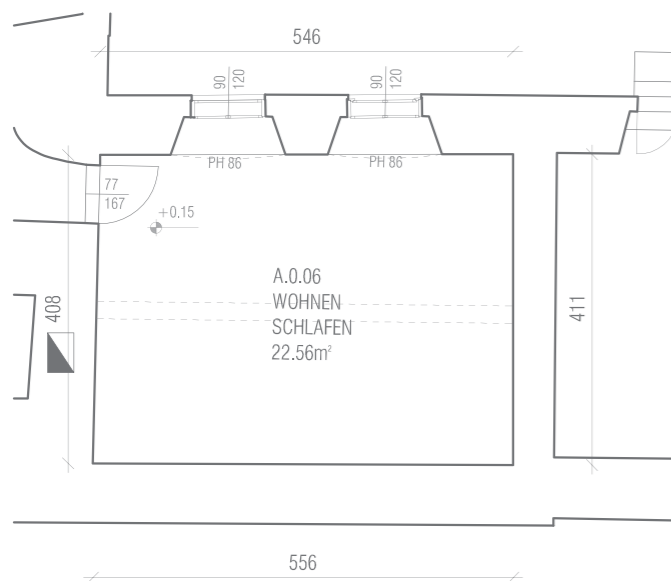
Grundriss Raum A.0.06_1:100
